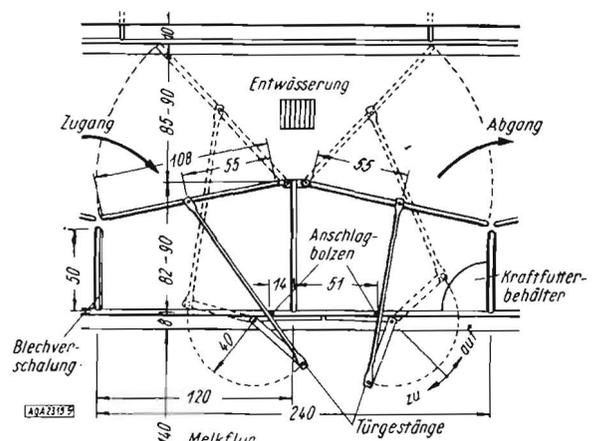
Grundriß der Melkbucht bei geschlossenen Türen
